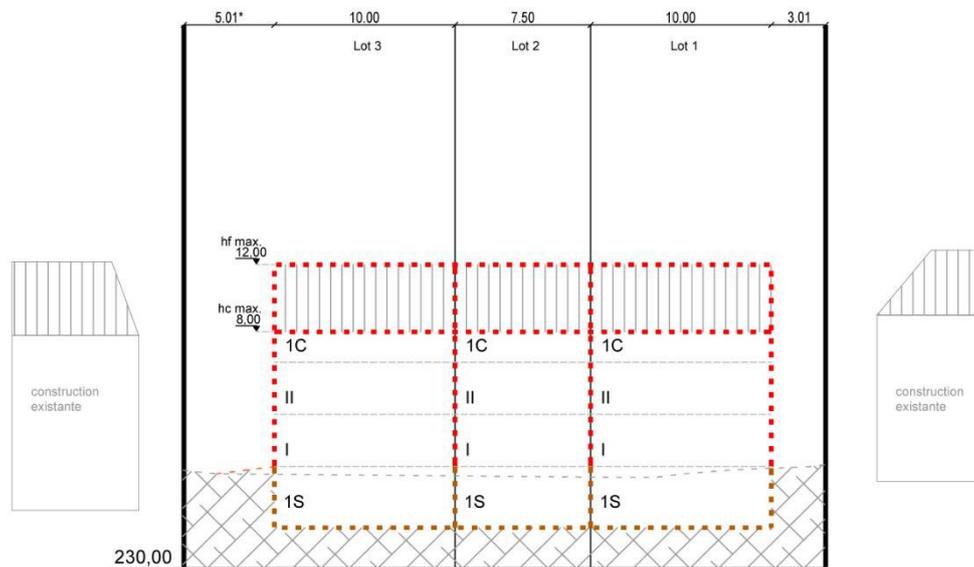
Coupe longitudinale du PAP. (Source : BEST)
